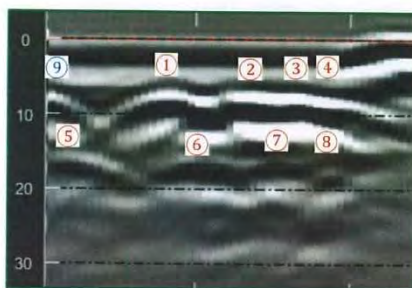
Radargramme du profil vertical sur poutre intermédiaire P3
